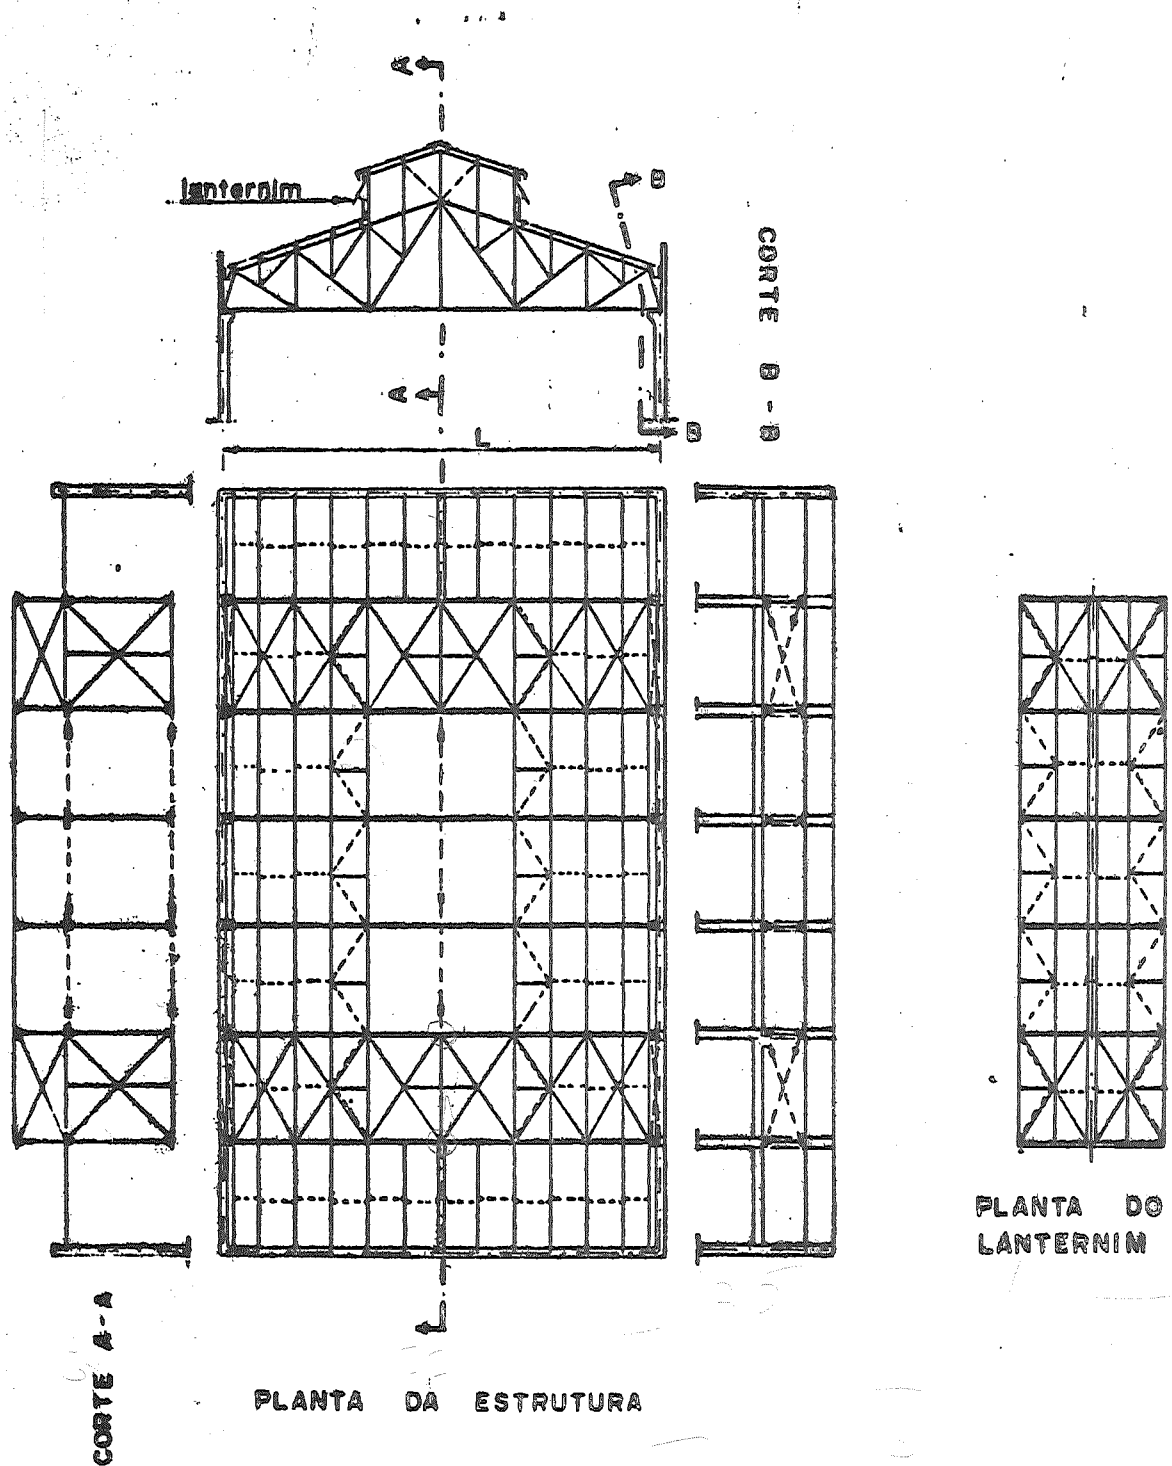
Estrutura para telhado de duas águas, com lanternim central para iluminação e ventilação natural.
